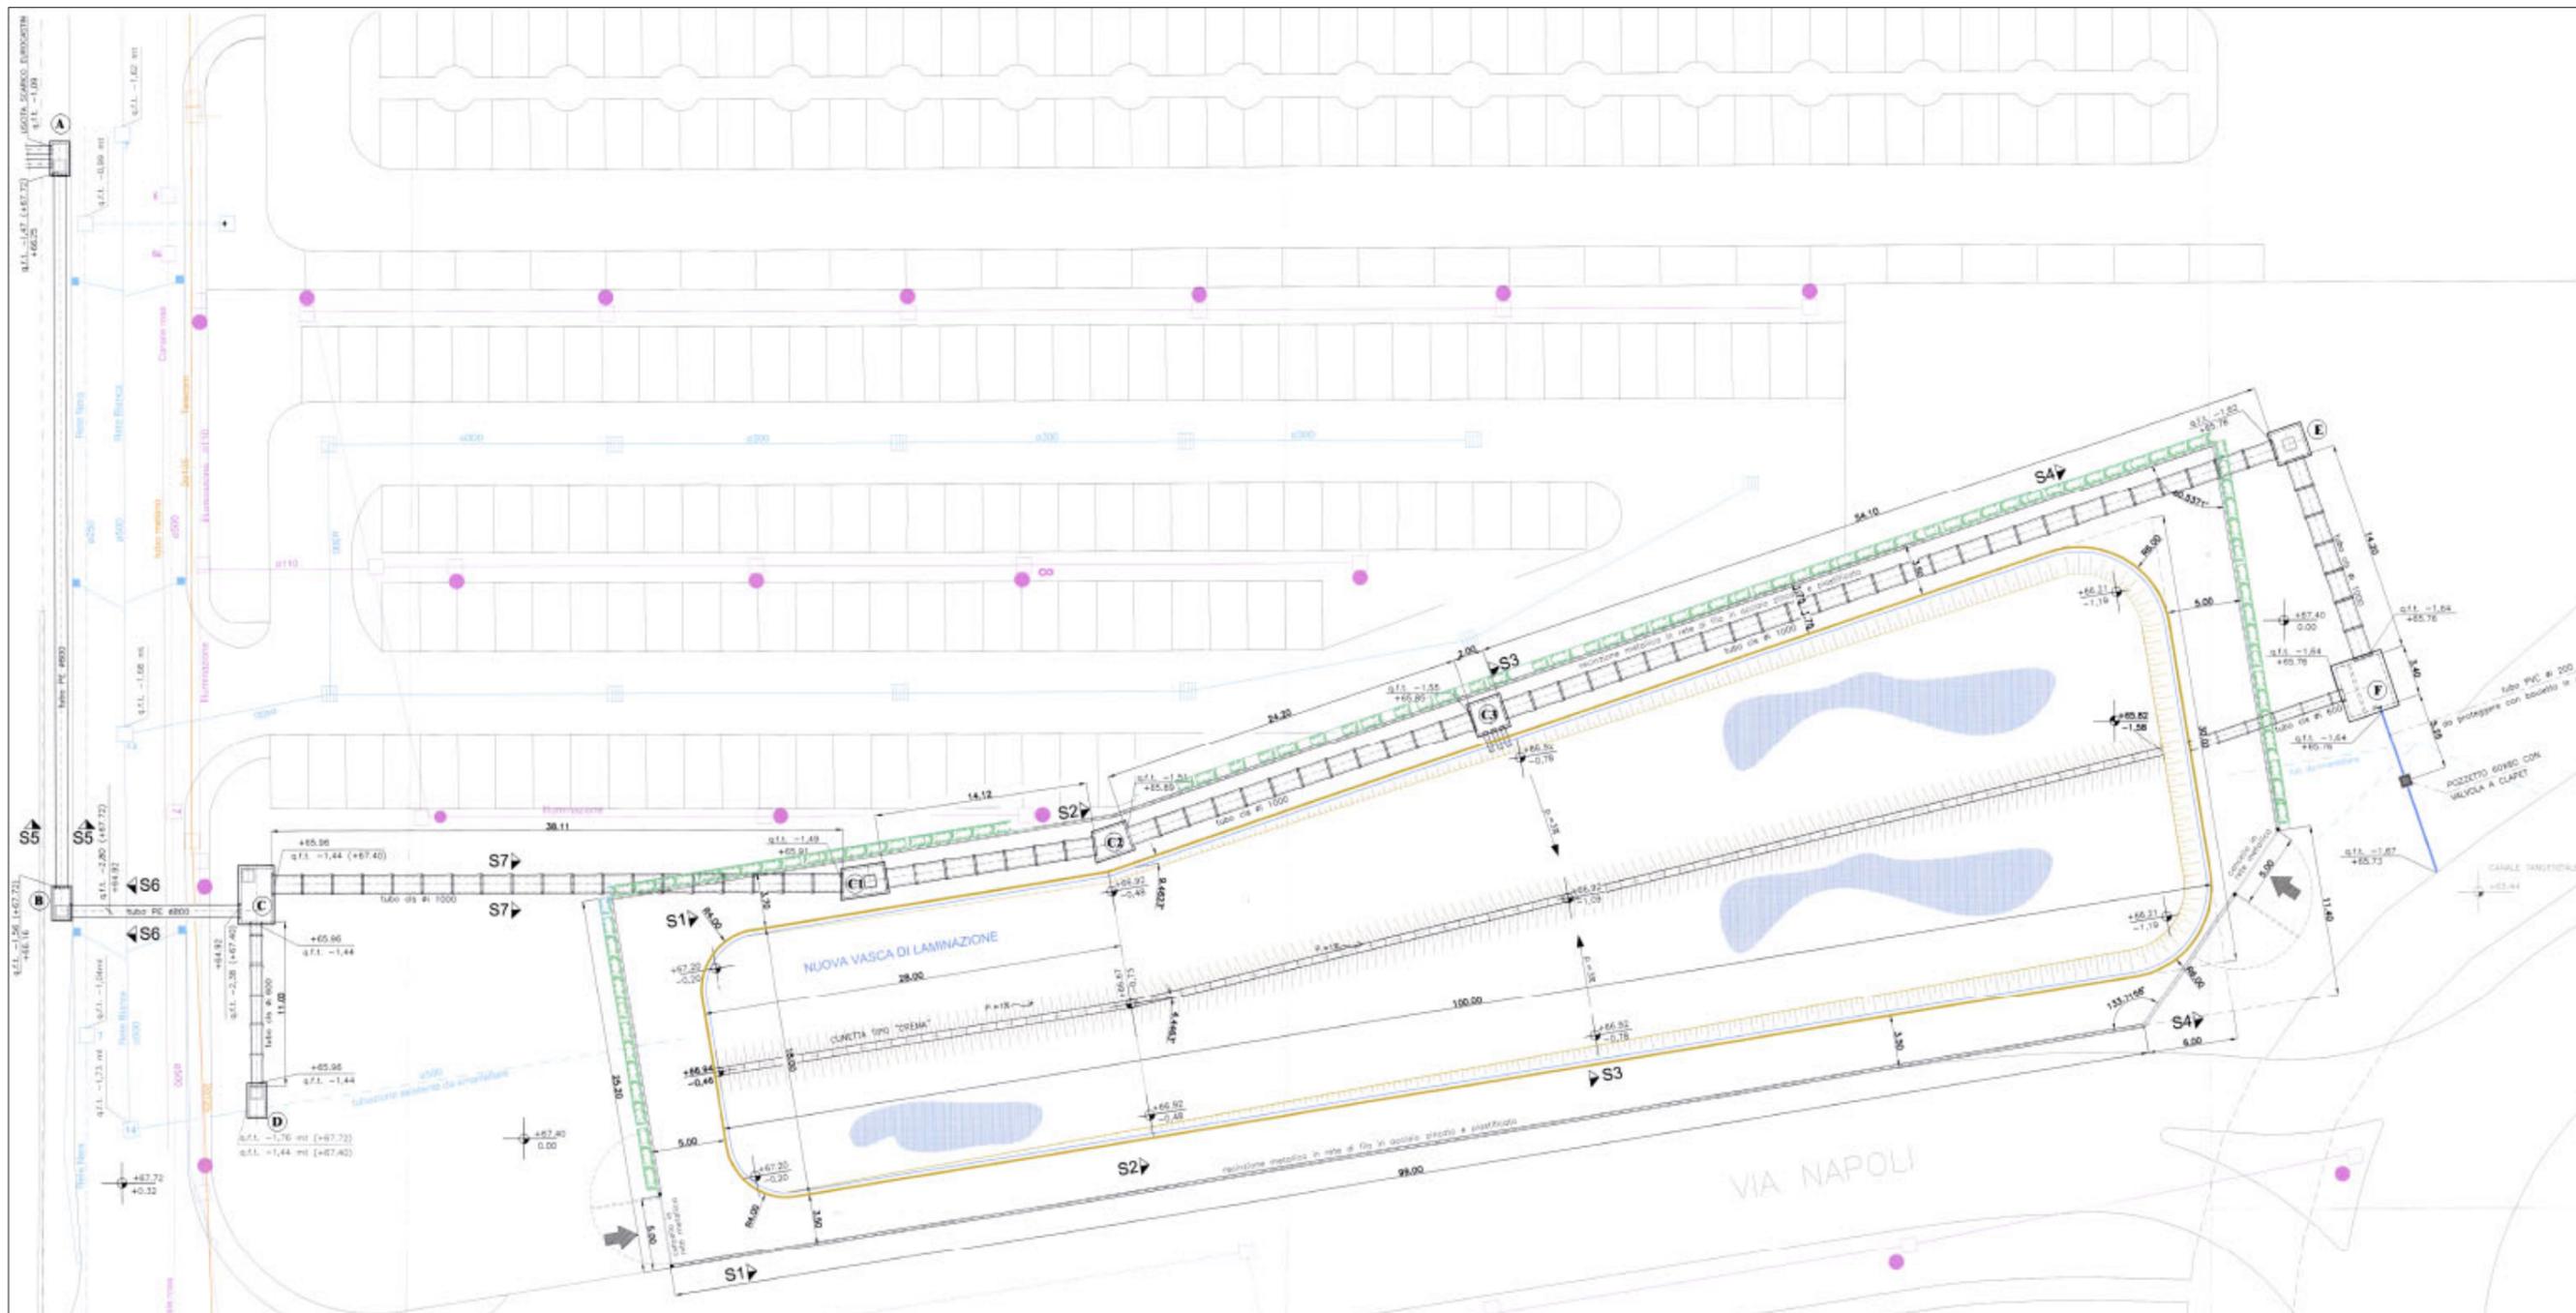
Planimetria rete smaltimento acque e vasca di laminazione esistente su Via F.lli Guerra – Progetto Approvato dal Comune di RE il 20/07/2010 atto n.10901/010
